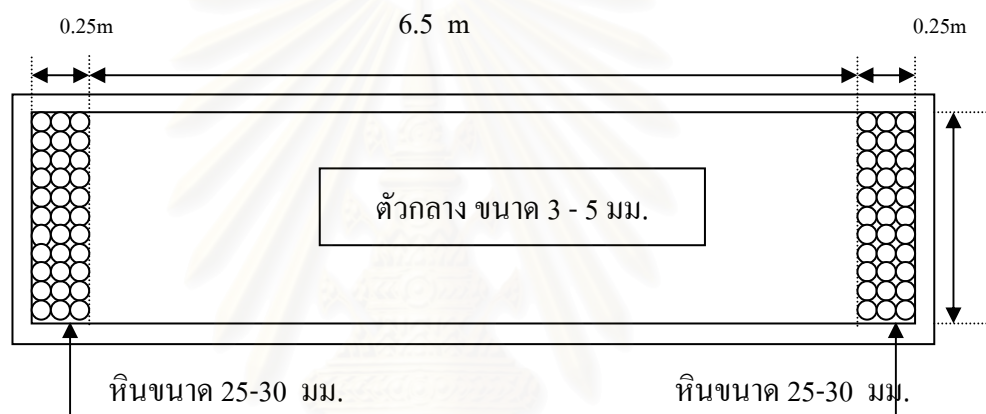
ภาพด้านข้างแนวกว้างของบึงประดิษฐ์
